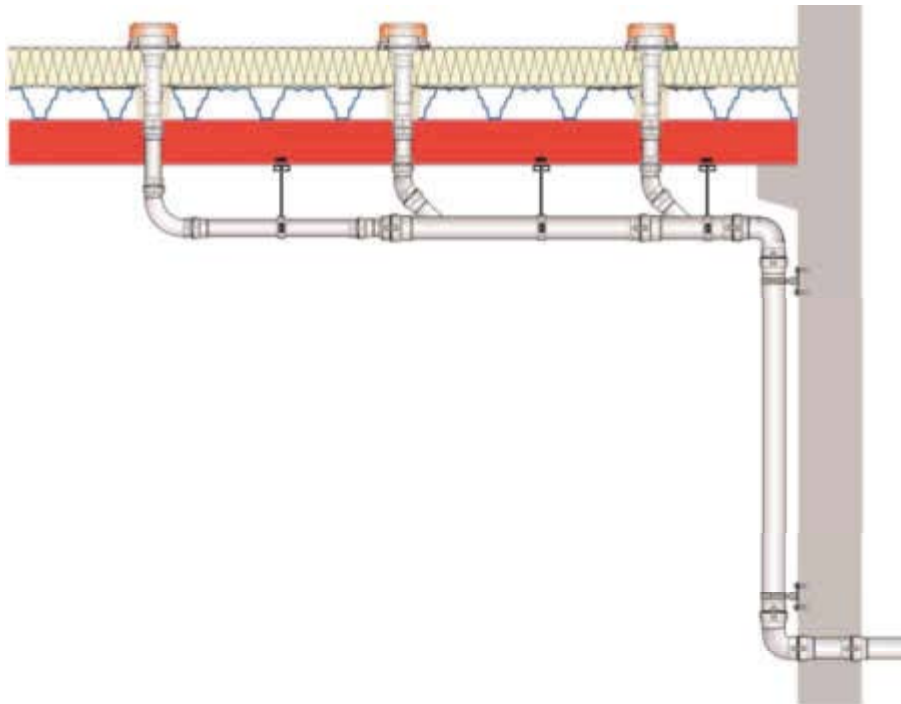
Not-Entwässerungsanlage mit freiem Auslauf über die Fassade auf schadlos überflutbare Grundstücksflächen
